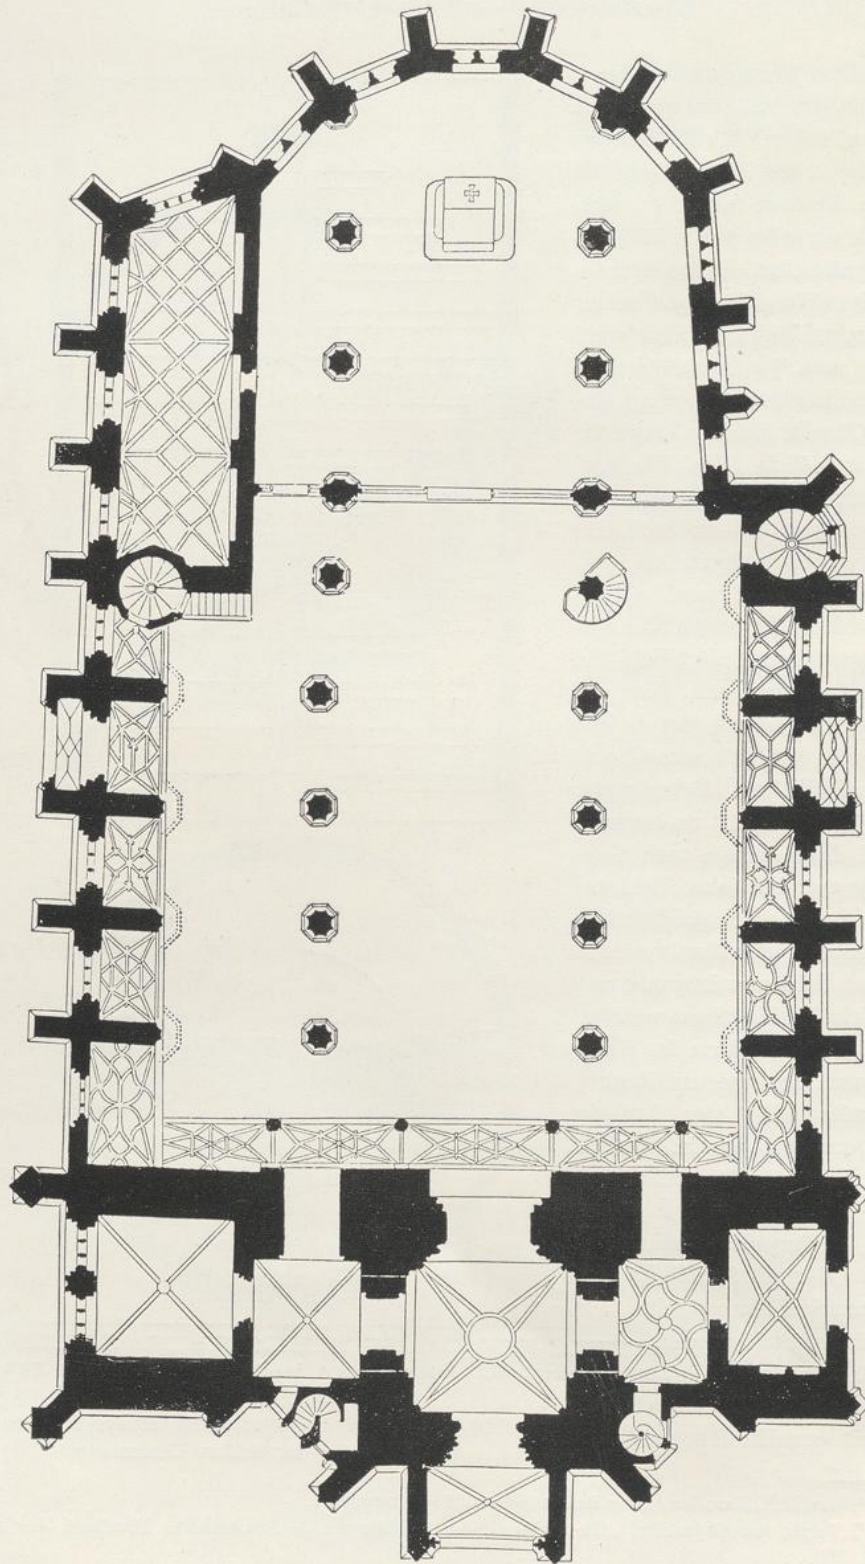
Marienkirche zu Zwickau. Grundriß.
